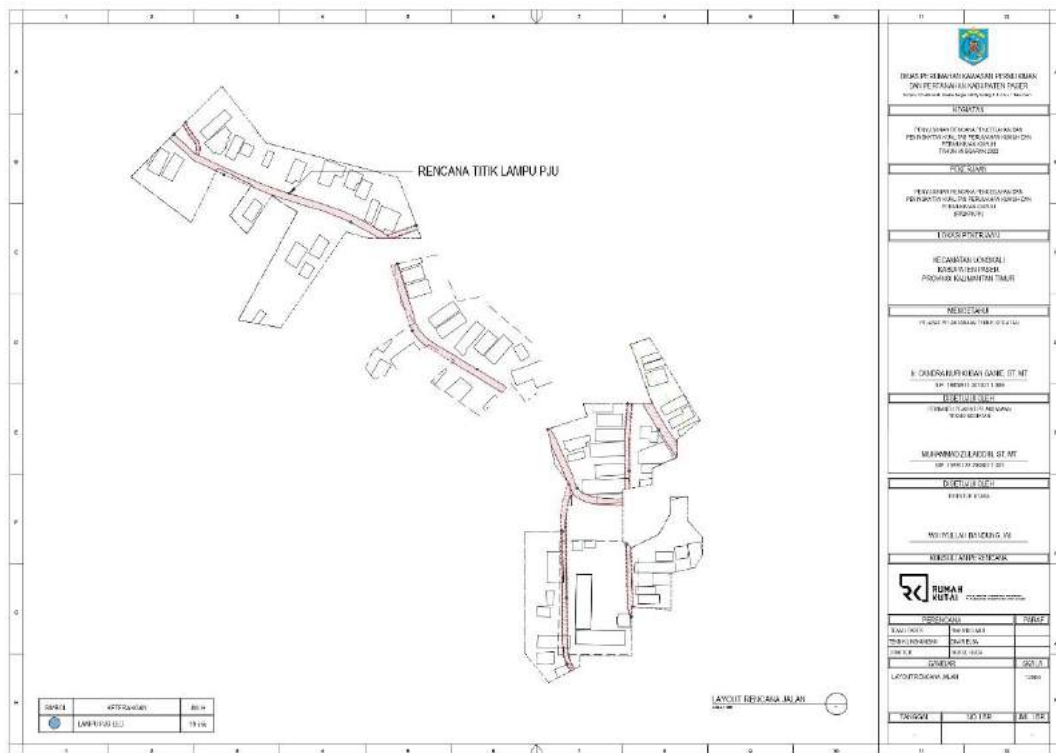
60 Konsep Rencana Jalan Segmen 9 RT.11
